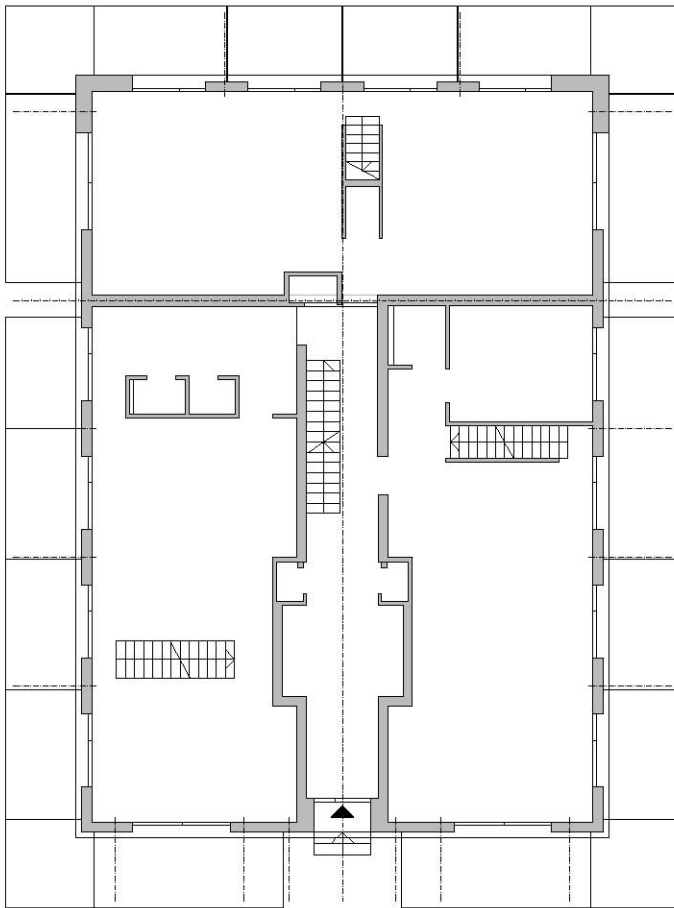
Grundriss EG, Projekt "Wolfurt"
